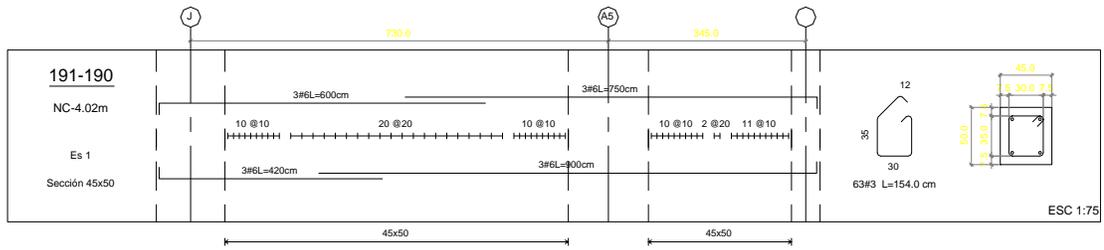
Vista longitudinal de viga de cimentación (Fuente: Departamento de diseño Metálicas e Ingeniería S.A.)
